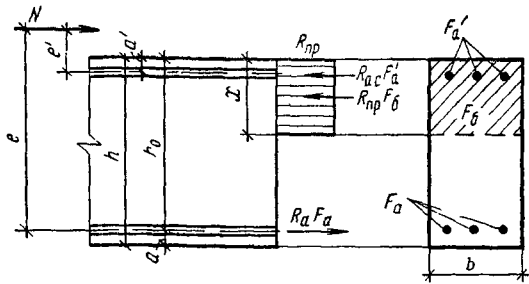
Схема усилий и эпюра напряжений в сечении, нормальном к продольной оси внецентренно-сжатого железобетонного элемента, при расчете его по прочности
